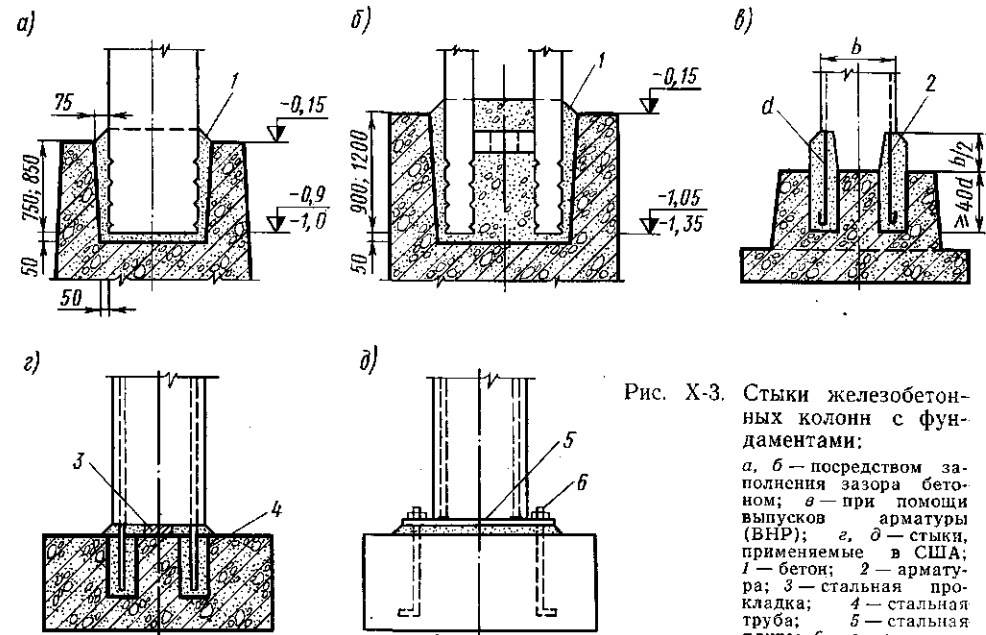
Стыки железобетонных колонн с фундаментами:
